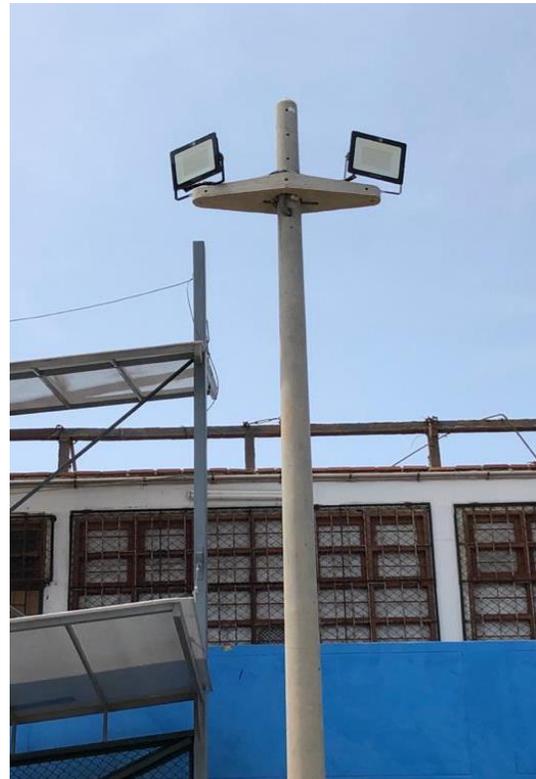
Retiro de Accesorios en columnas, zapatas y sardineles.
